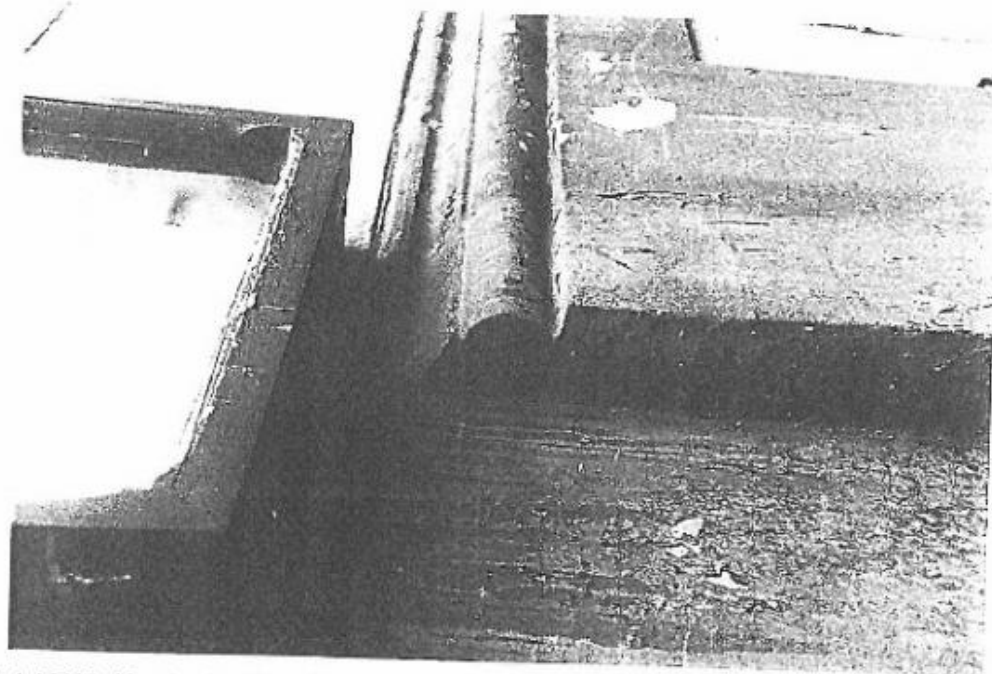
/10. Kamienica Rynek 1, elewacja południowa - detal drzwi.
